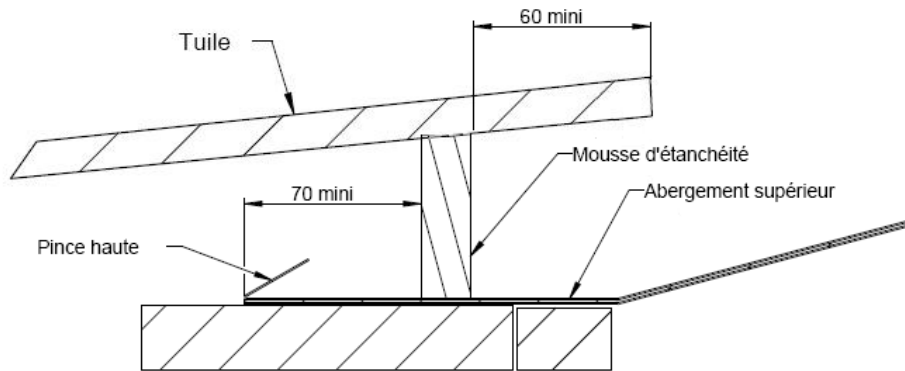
Mousse d'étanchéité abergement supérieur pour tuiles
